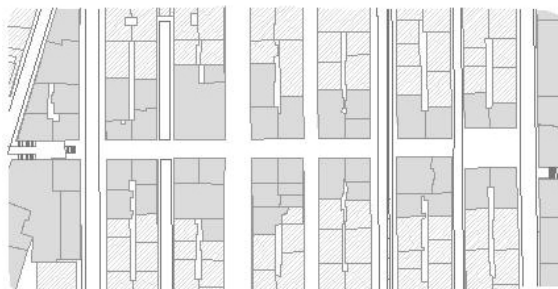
Planta da Rua de Santa Justa (anexo A01)
